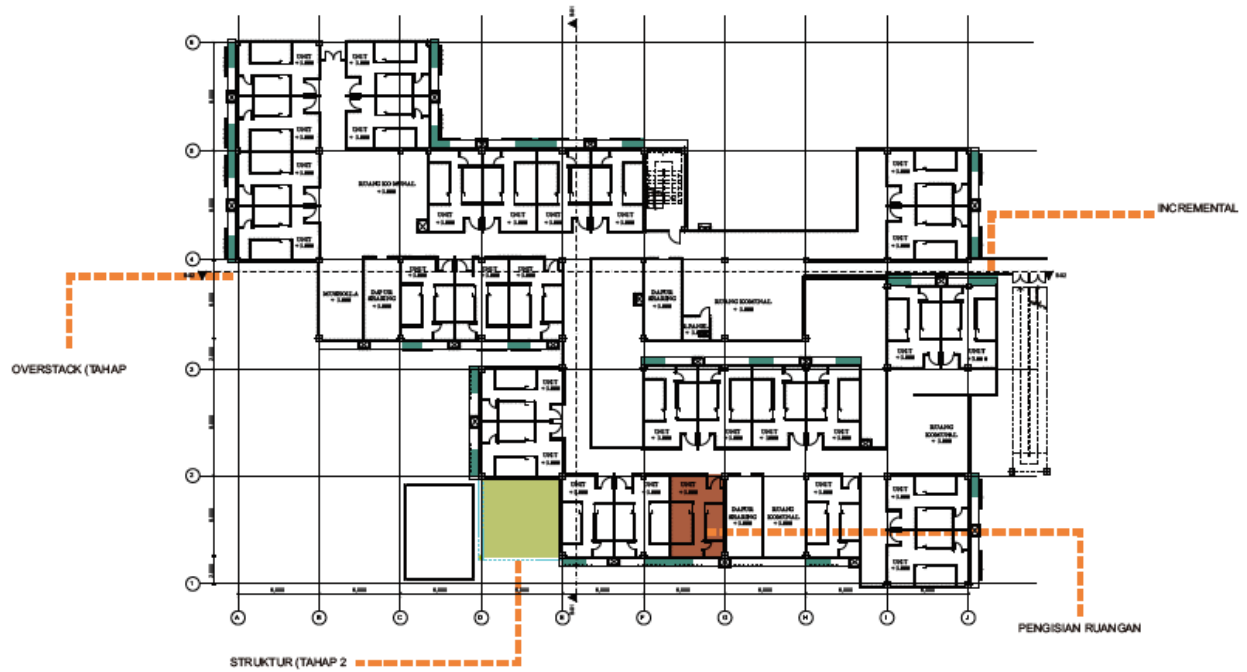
Tahapan Pembangunan Detail Perblok
